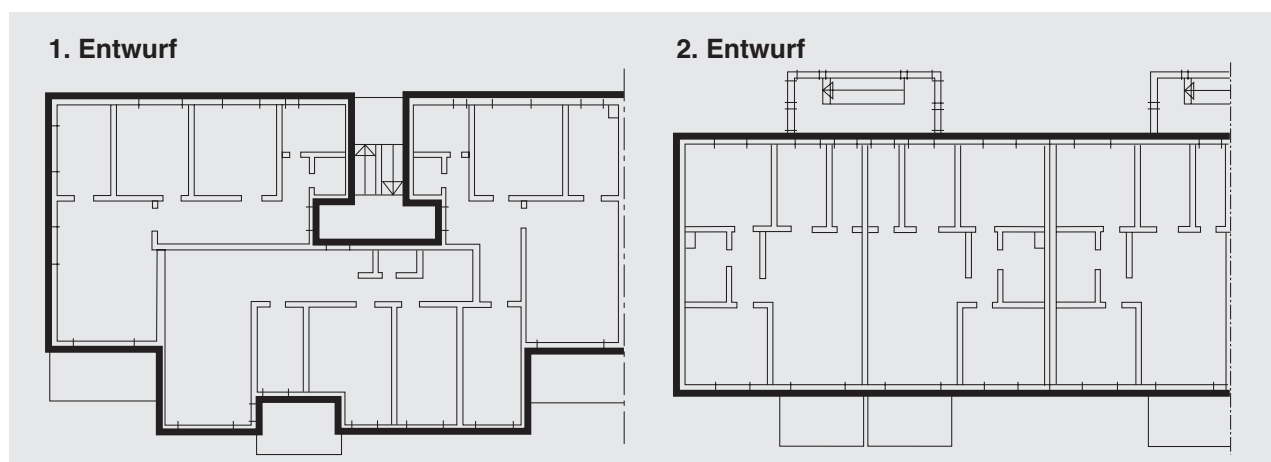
Darstellung einer Hälfte des Geschoßgrundrisses des ersten und zweiten Entwurfs.
